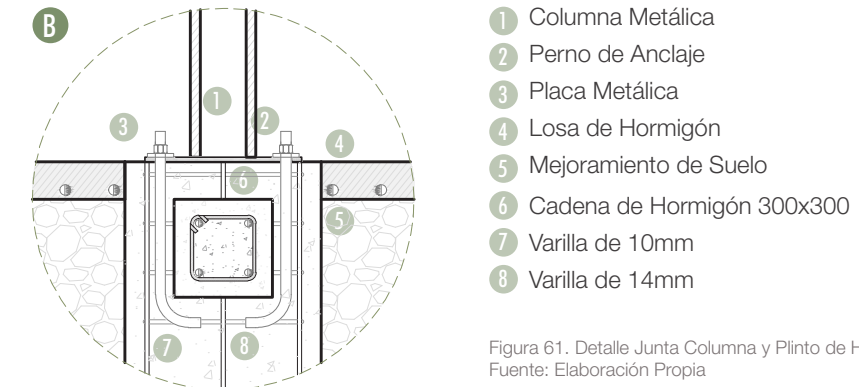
Detalle Junta Columna y Plinto de Hormigón
